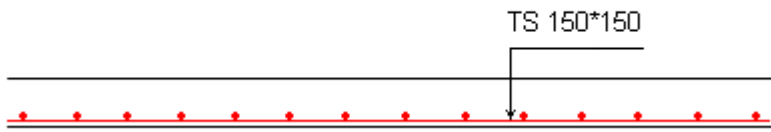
schéma de ferrailage De la dalle de compression.
